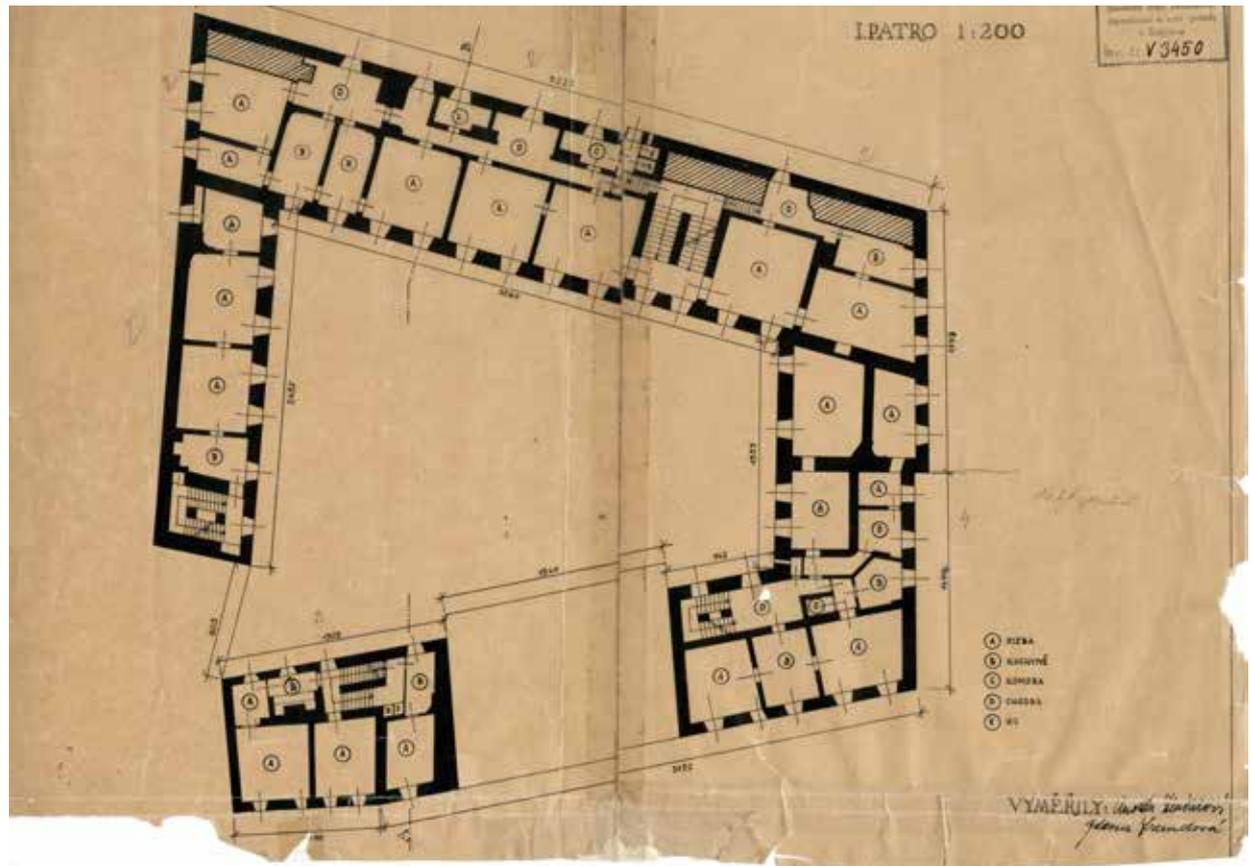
Grundriss Obergeschoss, Zeitpunkt der Zeichnung unbekannt
